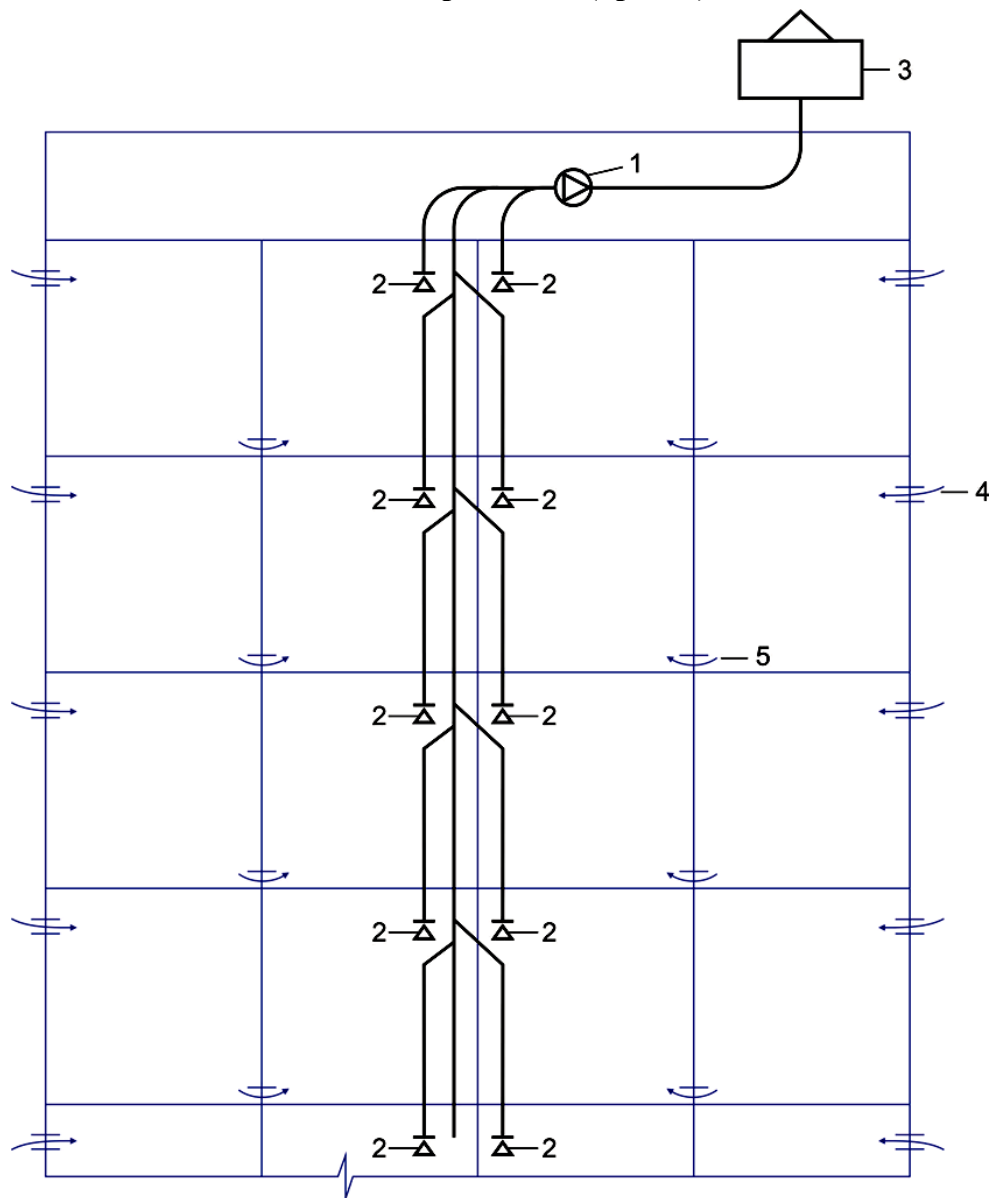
Схема системы вытяжной вентиляции с вытяжными вентиляторами на последних двух этажах и «теплым чердаком»
